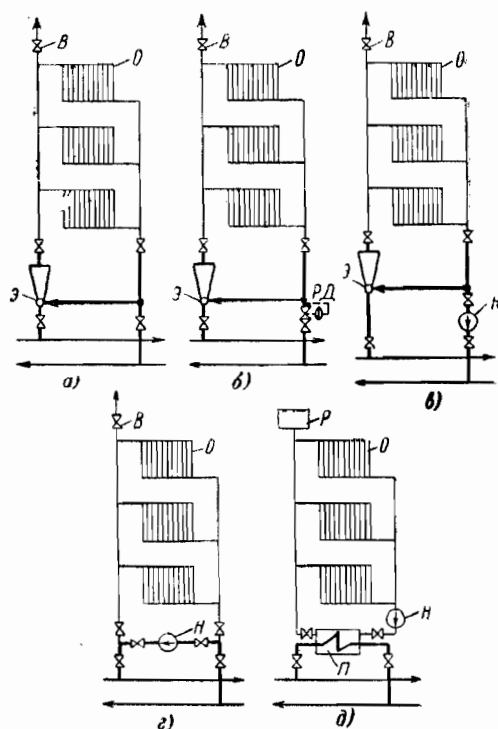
Схемы присоединения отопительных установок к водяной тепловой сети.
